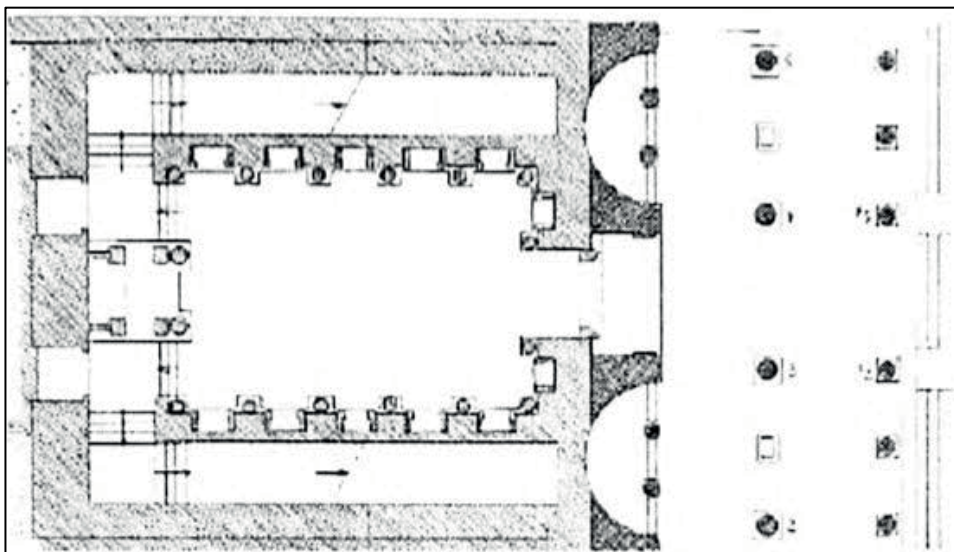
Planta de la posible Biblioteca de Nîmes.
